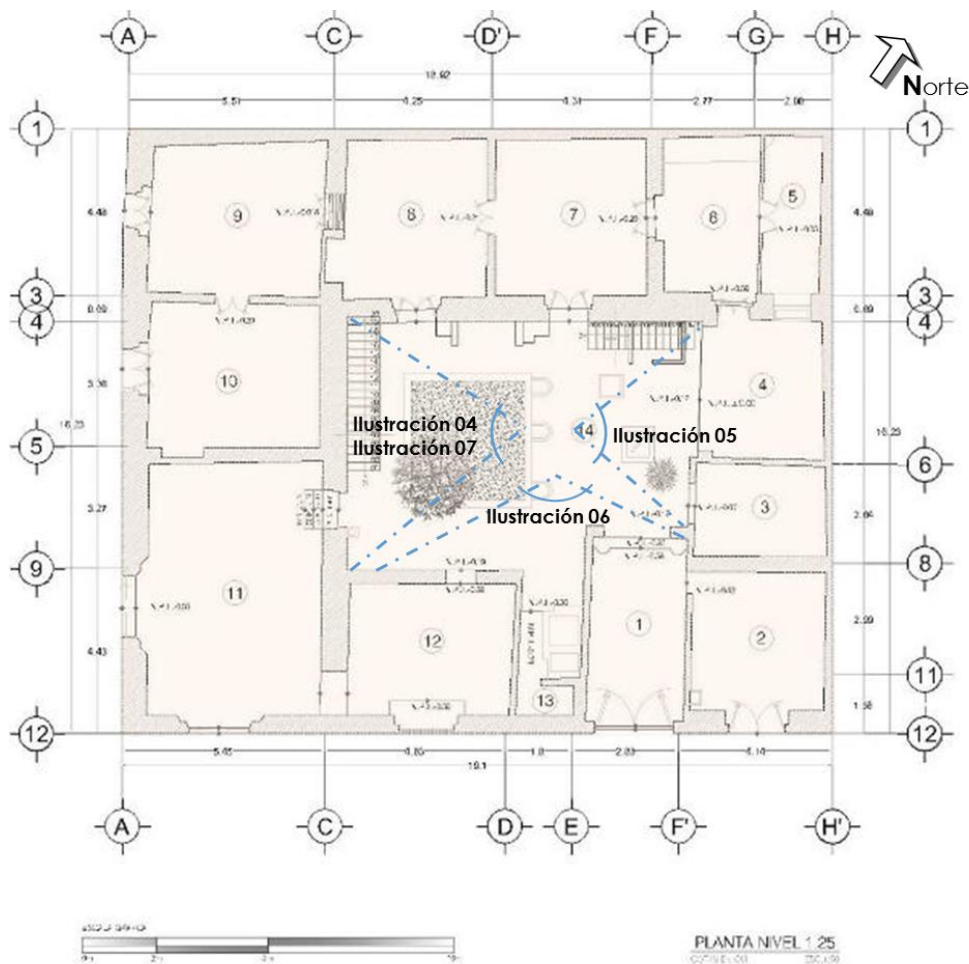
Núñez Gina, Sánchez Jacqueline, Espinoza Francisco, Gutiérrez Miguel A. 2013. Levantamiento arquitectónico (planta baja), casona del barrio de Análco, calle 14 sur 507. Referencia a la primera etapa de intervención.
